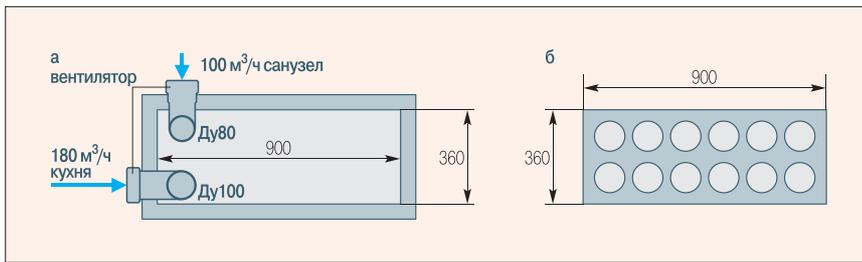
Примеры технических решений вентиляционных блоков многоэтажных домов (а — блок с каналами-спутниками для кухни и санузла группы квартир 16-этажного дома; б — многоканальный железобетонный блок санузлов 12-этажного дома с каналами диаметром 100 мм)
